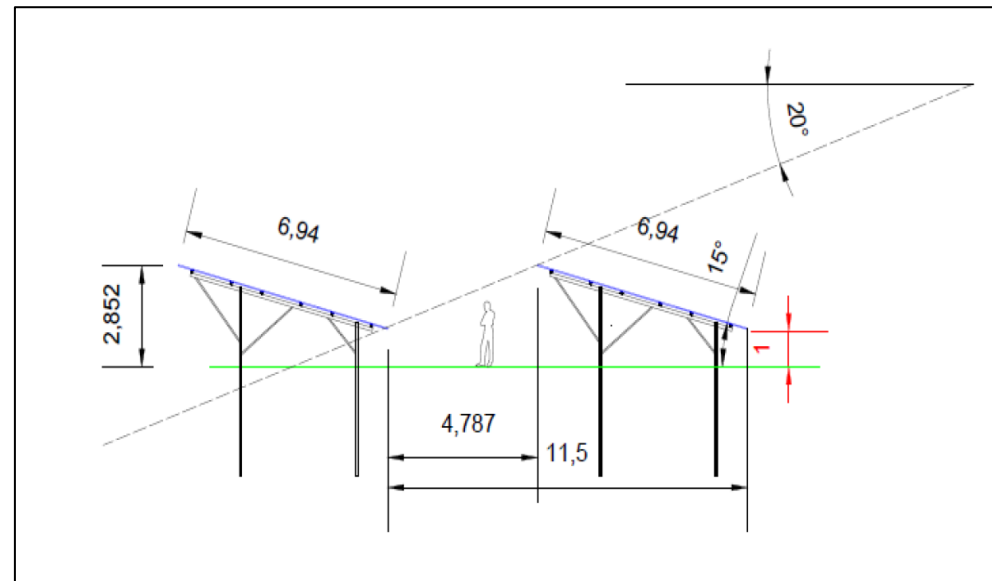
Esquisse de la structure des panneaux de la zone est (avec éco-pâturage sous panneaux)
